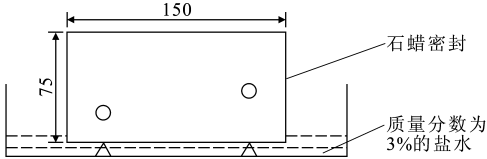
加钢筋混凝土氯离子侵蚀试验示意(单位:mm)
